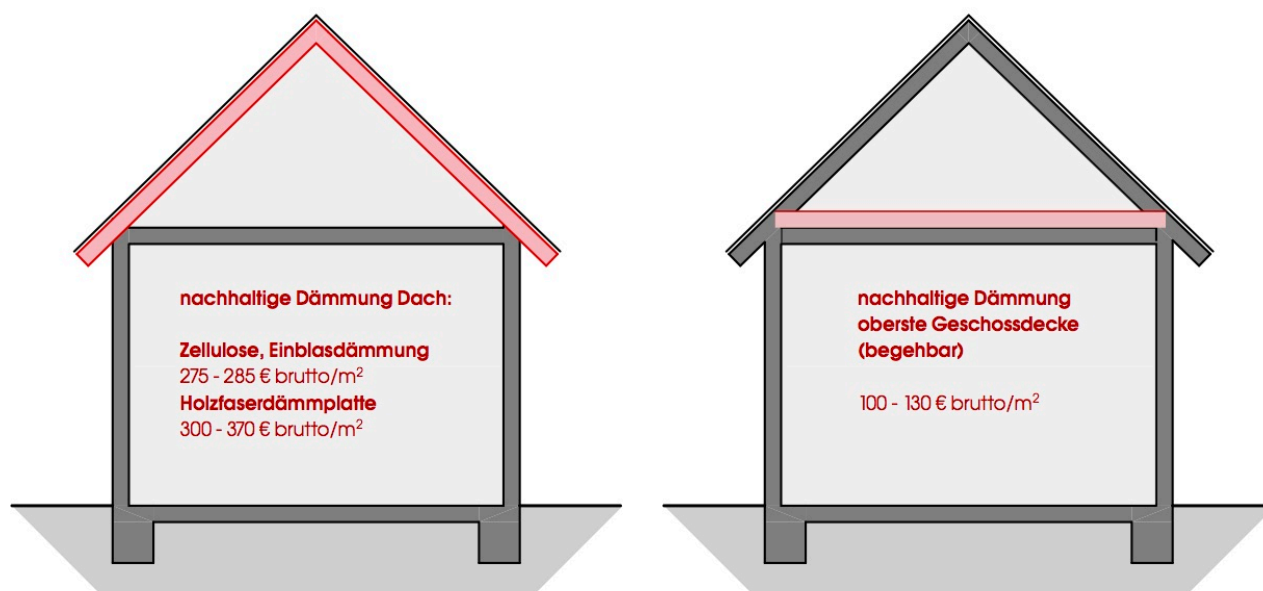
Kostenübersicht nachhaltige Dämmung Dach und oberste Geschossdecke, bauart Architekten
